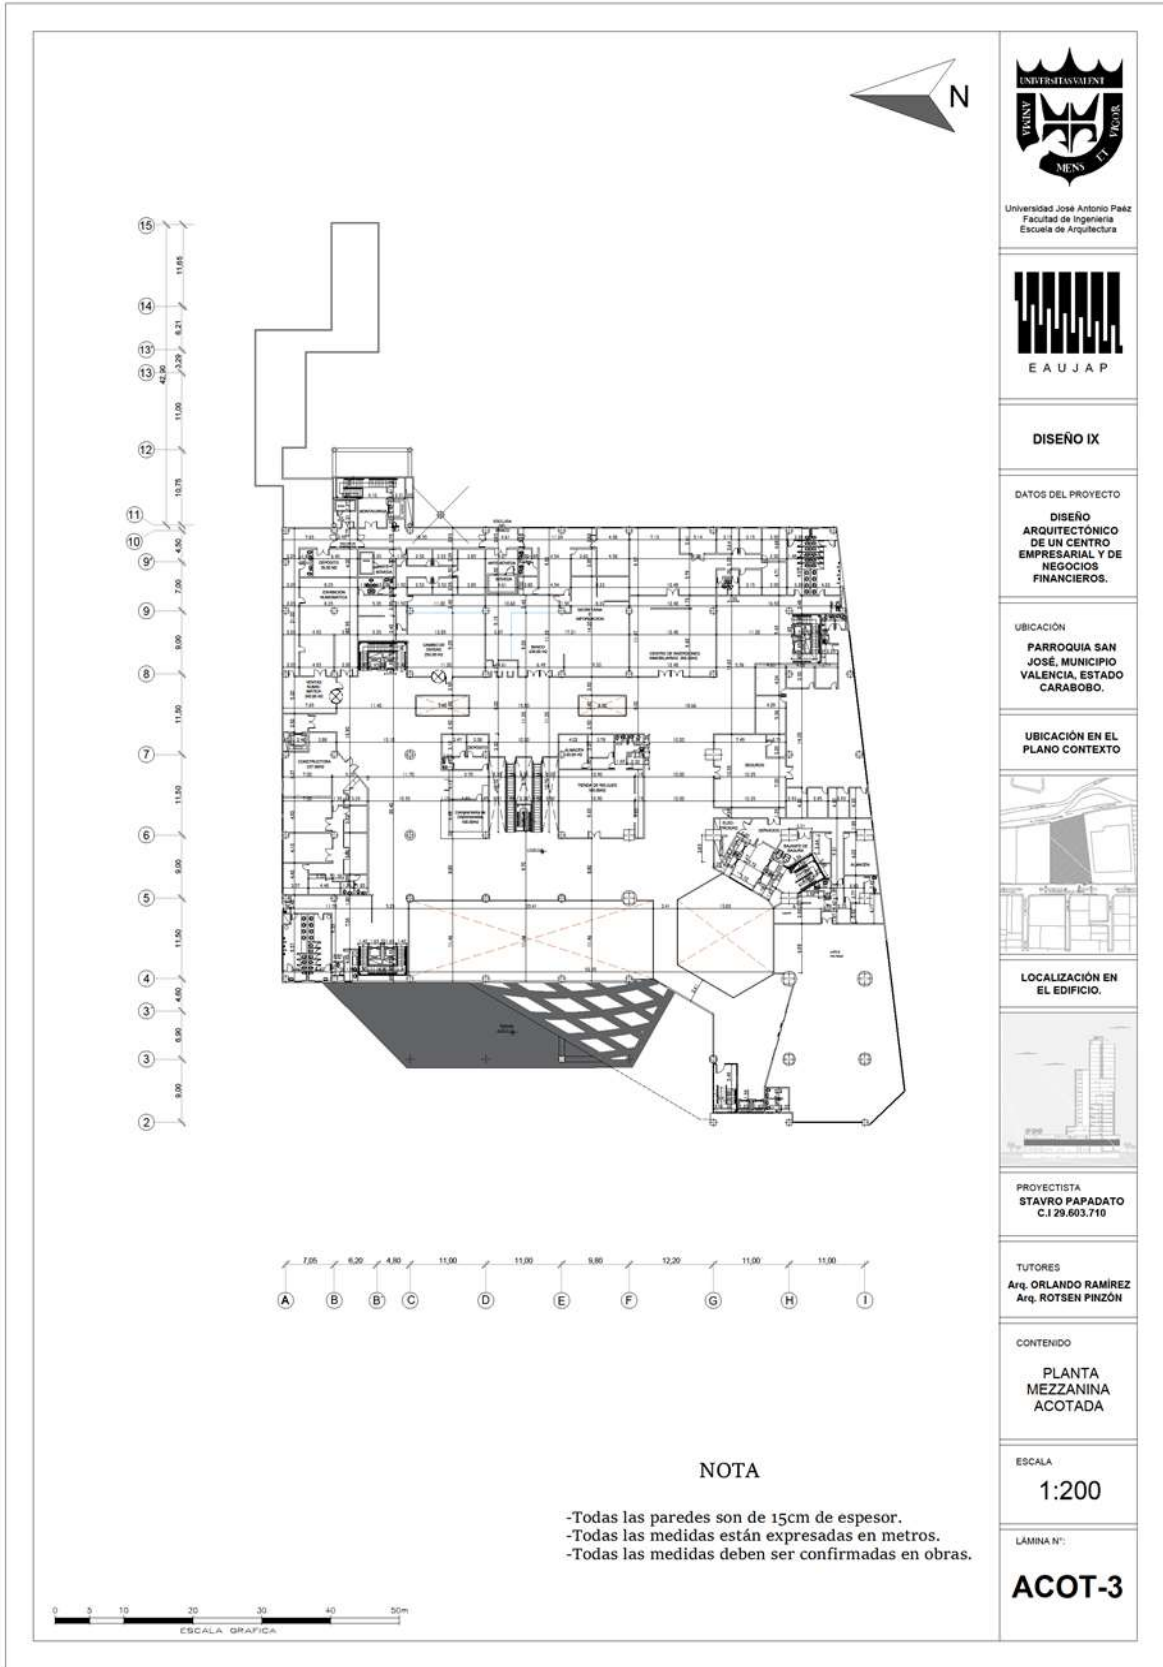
ACOT – 3 Planta Mezzanina Acotada Fuente: El Autor (2023)
